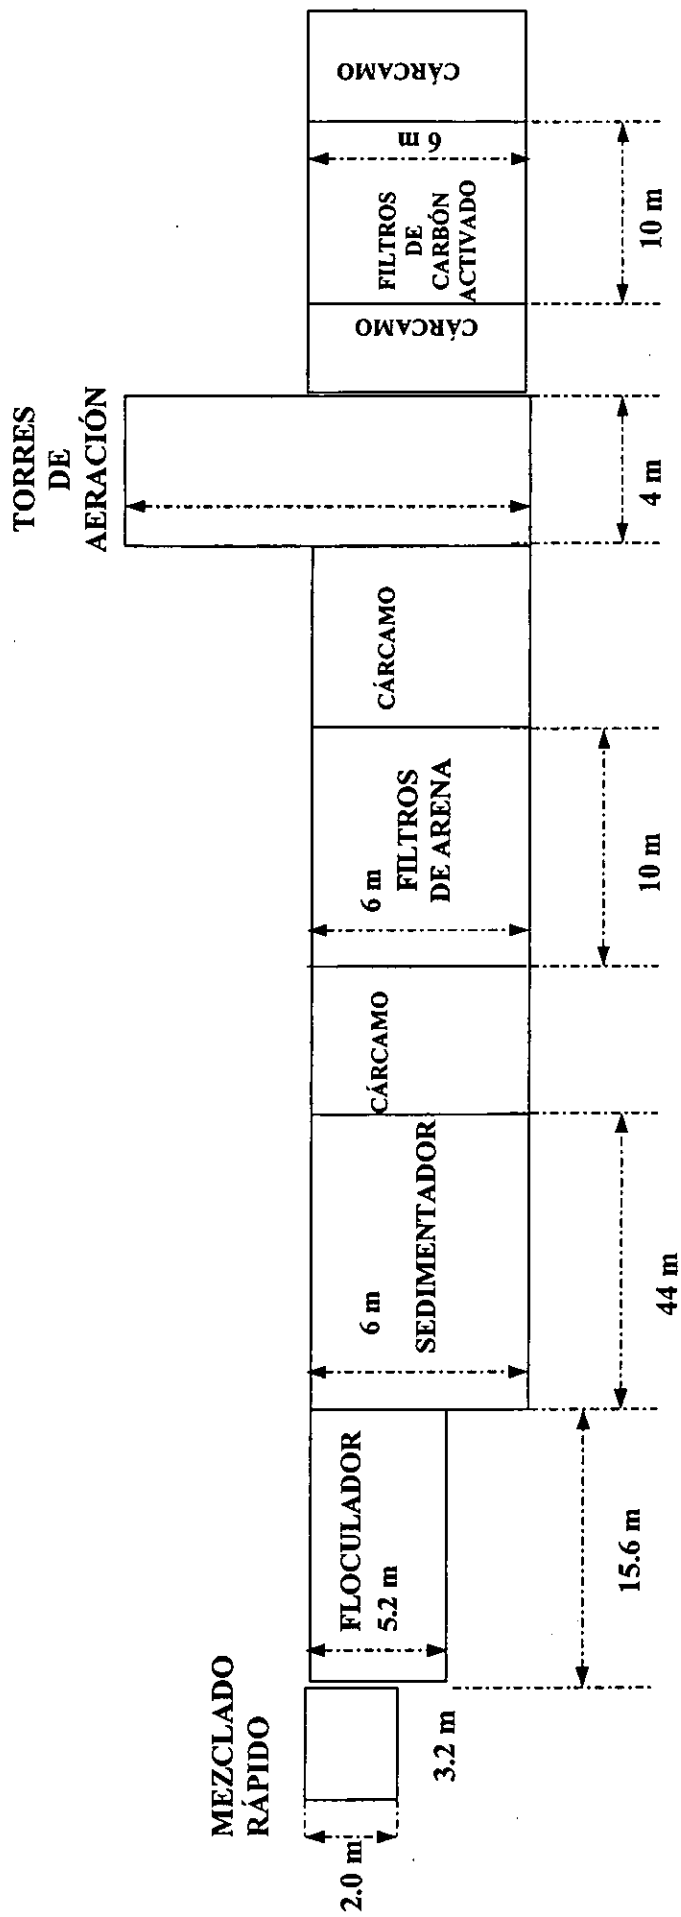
Vista lateral de la planta de tratamiento propuesta
